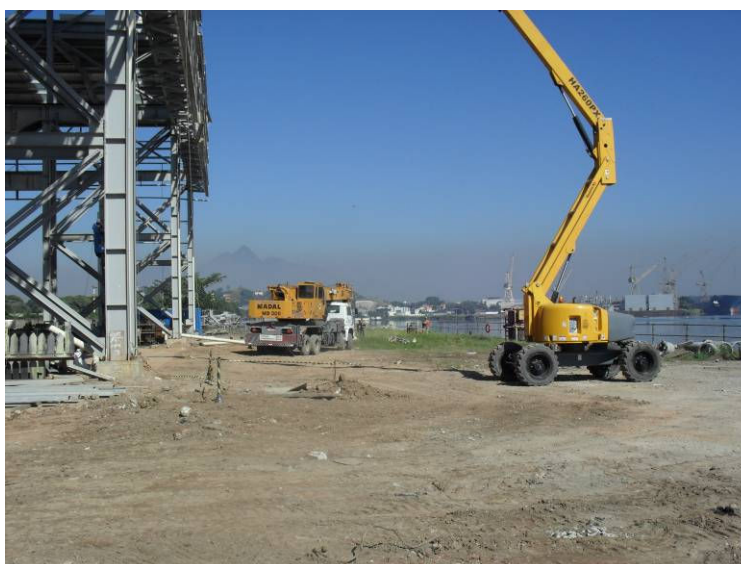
Atividade de prospecção da AID, no detalhe: construção de pavilhões em área ao lado do ponto de GPS 1. Em 11/07/11.
